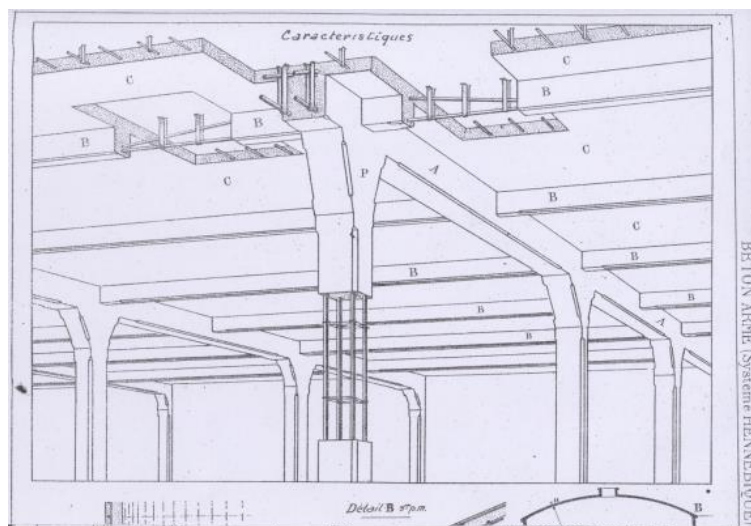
Sistema Hennebique de betão armado (Appleton, 2013)
